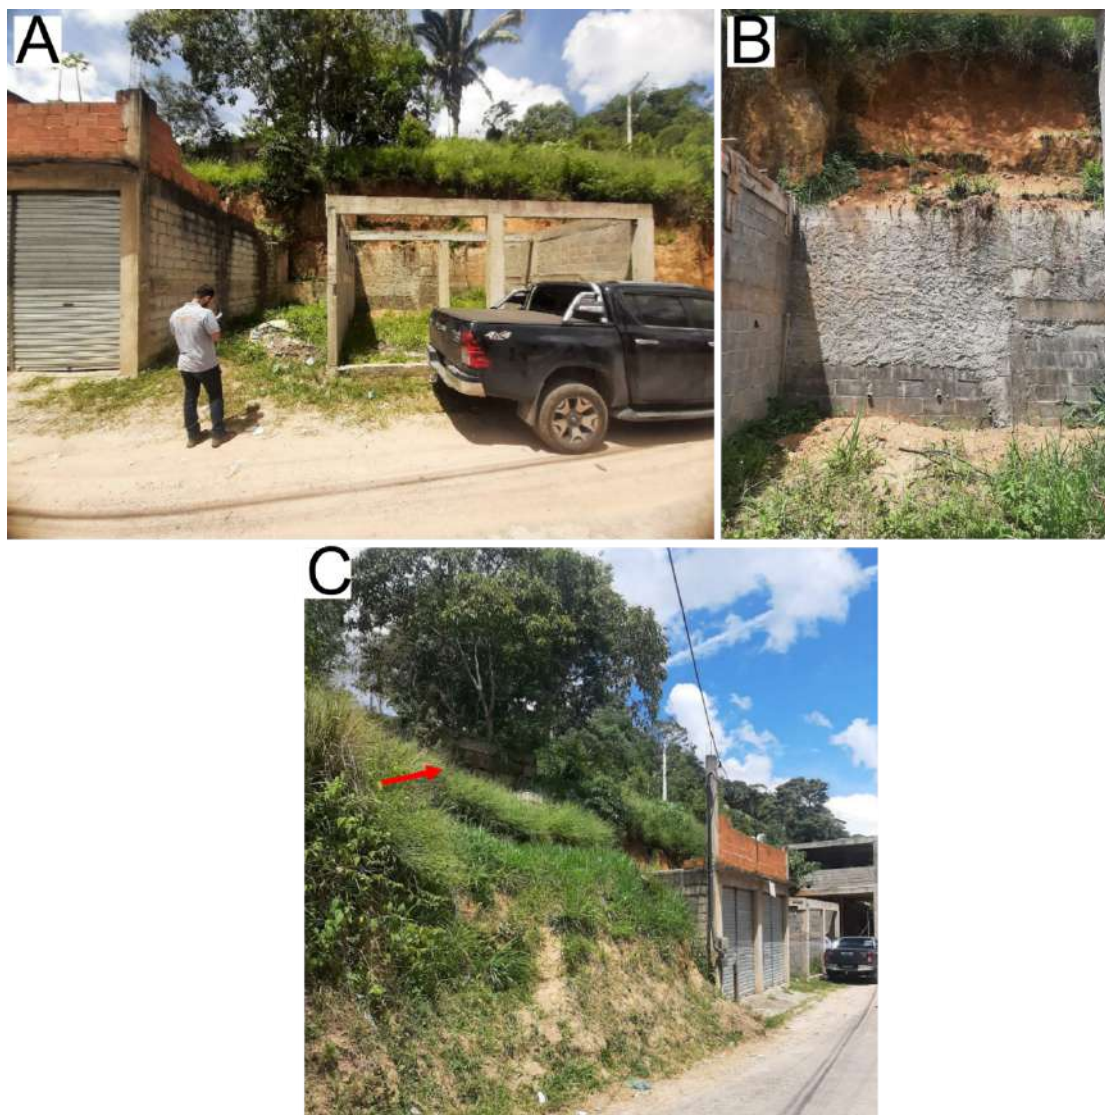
A – As duas construções próximas a edificação. B – Muro de blocos de concreto e drenos. Cicatriz de deslizamento. C – Altura do talude, vegetação e construção de concreto não identificada (seta vermelha).
